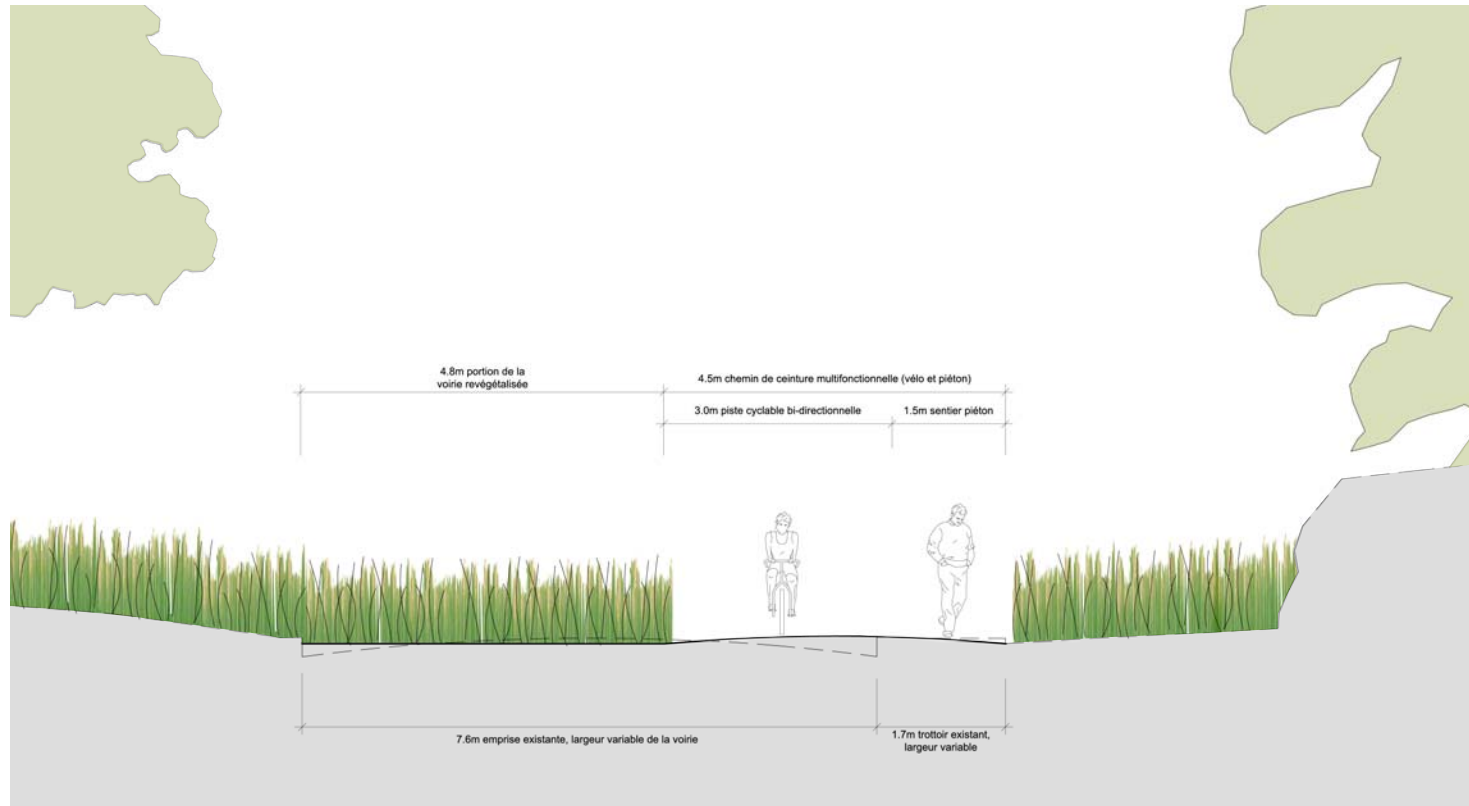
Coupe transversale 03, chemin de ceinture, échelle 1:100
